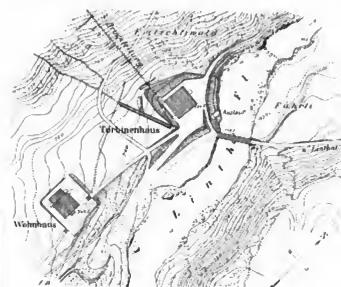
Lageplan der Kraftzentrale. — Mastab 1:2000.
